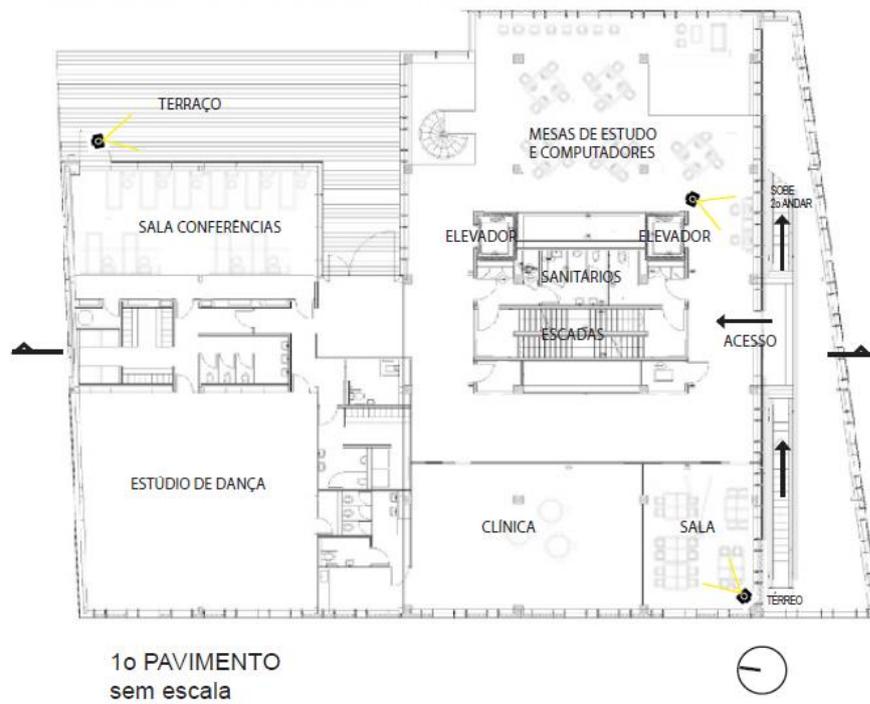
Planta do Primeiro Pavimento da *Idea Store Whitechapel* (LI, 2013)
